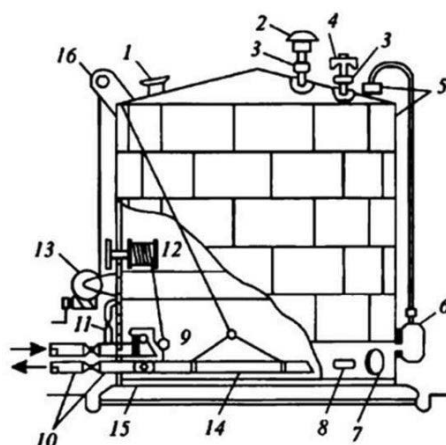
Схема расположения оборудования вертикального резервуара «1– световой люк; 2 – предохранительный клапан; 3– огневой предохранитель; 4 –дыхательный клапан; 5 – замерный люк; 6 – указатель уровня; 7 – люк – лаз; 8 – сифонный кран; 9 – хлопушка; 10 – приемно – раздаточные патрубки; 11 –
